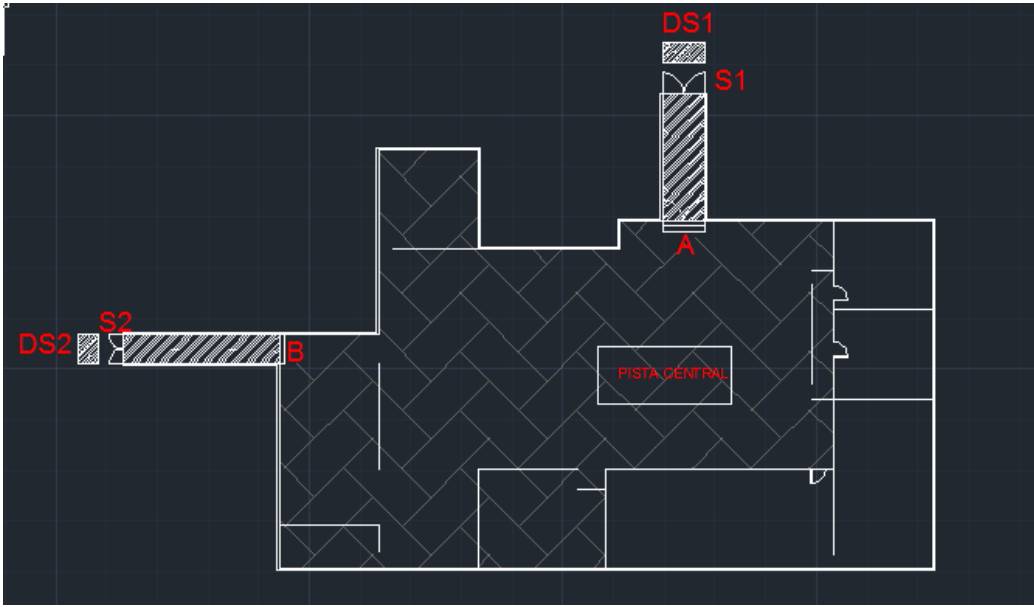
“Plano de la planta de la discoteca 3 en formato DXF.”
